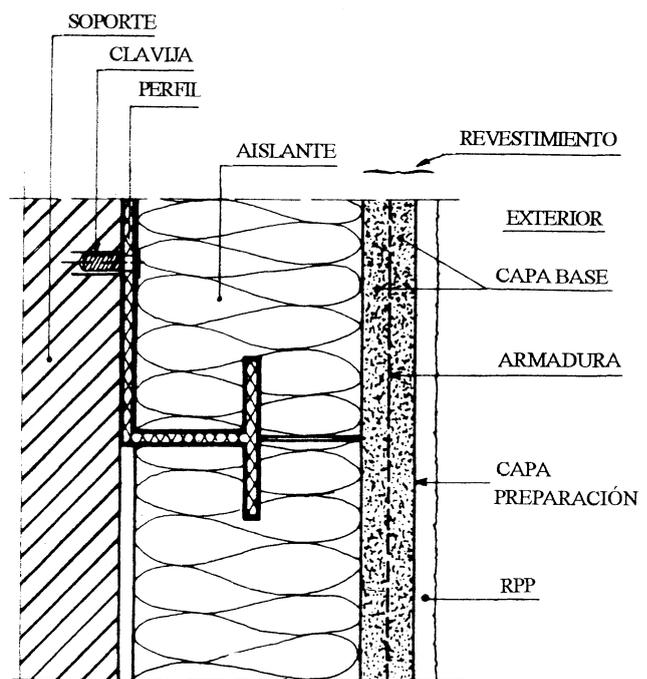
bis.- Sistema de aislamiento exterior de fachadas con revestimiento delgado sobre aislante, fijado mecánicamente.
